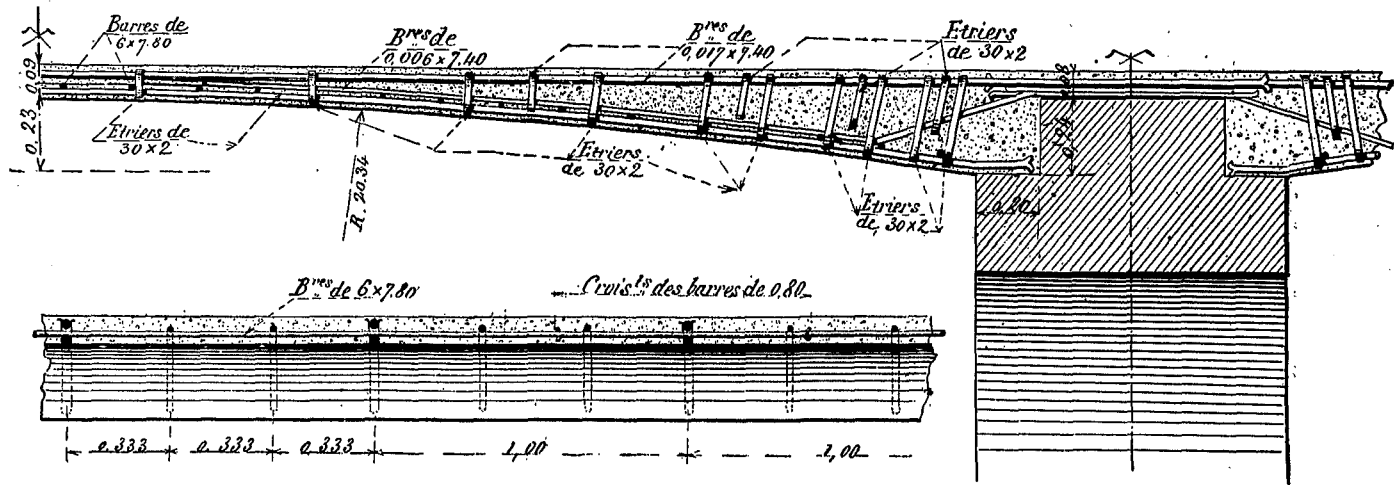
et 11. — Plancher en béton armé (premier type en voûte).
